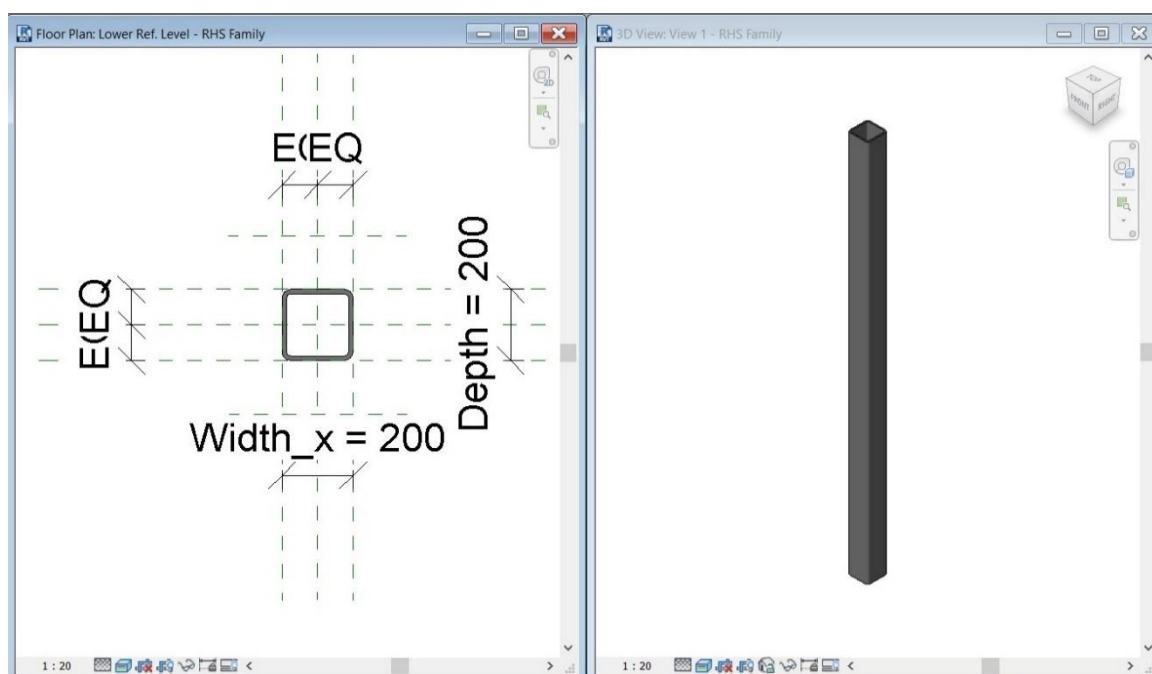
Secção e vista 3D do perfil modelado em *Revit*®.
